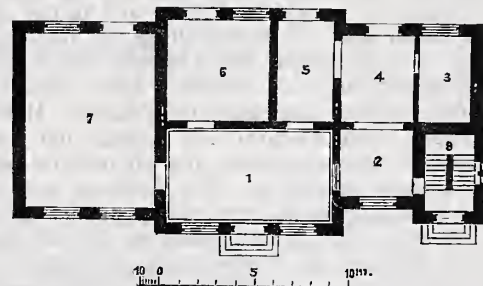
Grundriss vom Erdgeschoss.
